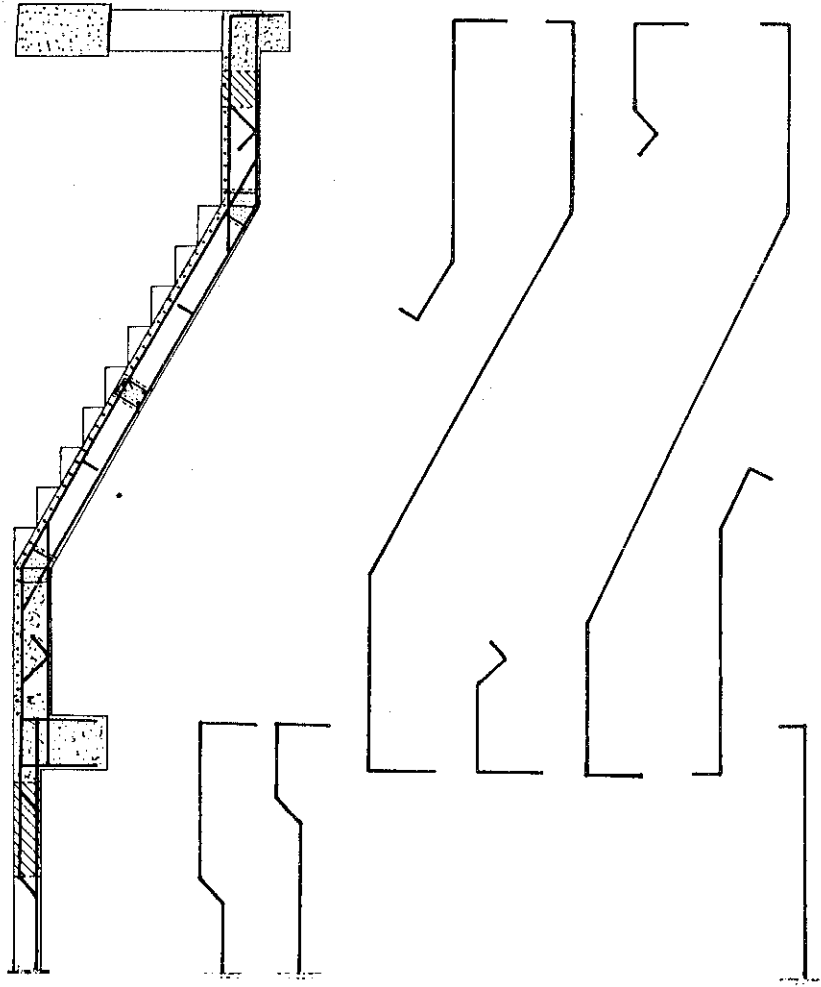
Disposizione delle armature dei travetti (rampa in discesa)
